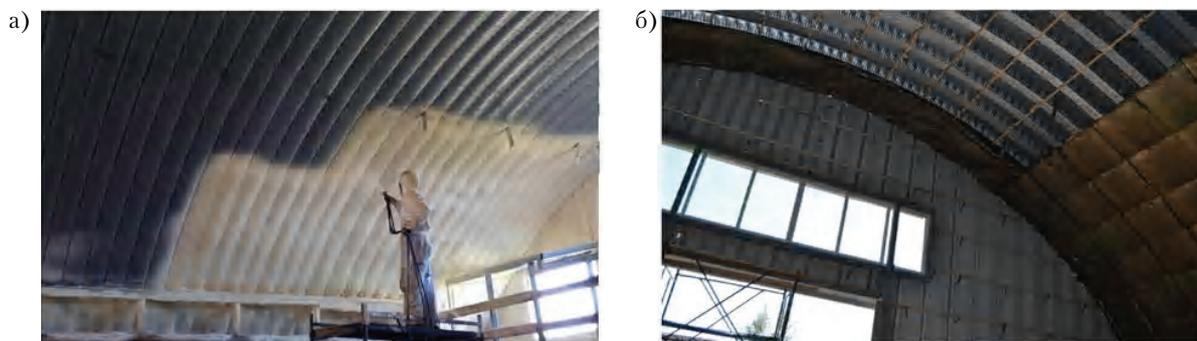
Варианты с внутренним утеплением сводчатого покрытия: а) утепление пенополиуретаном; б) утепление минераловатными плитами.
